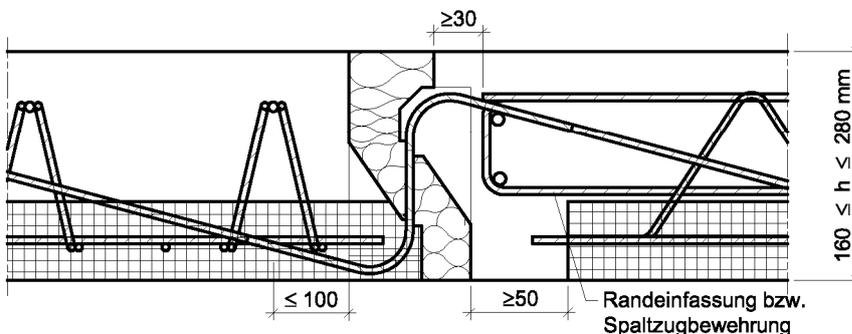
Beispiel Schöck Isokorb Typ V mit Elementplatten
